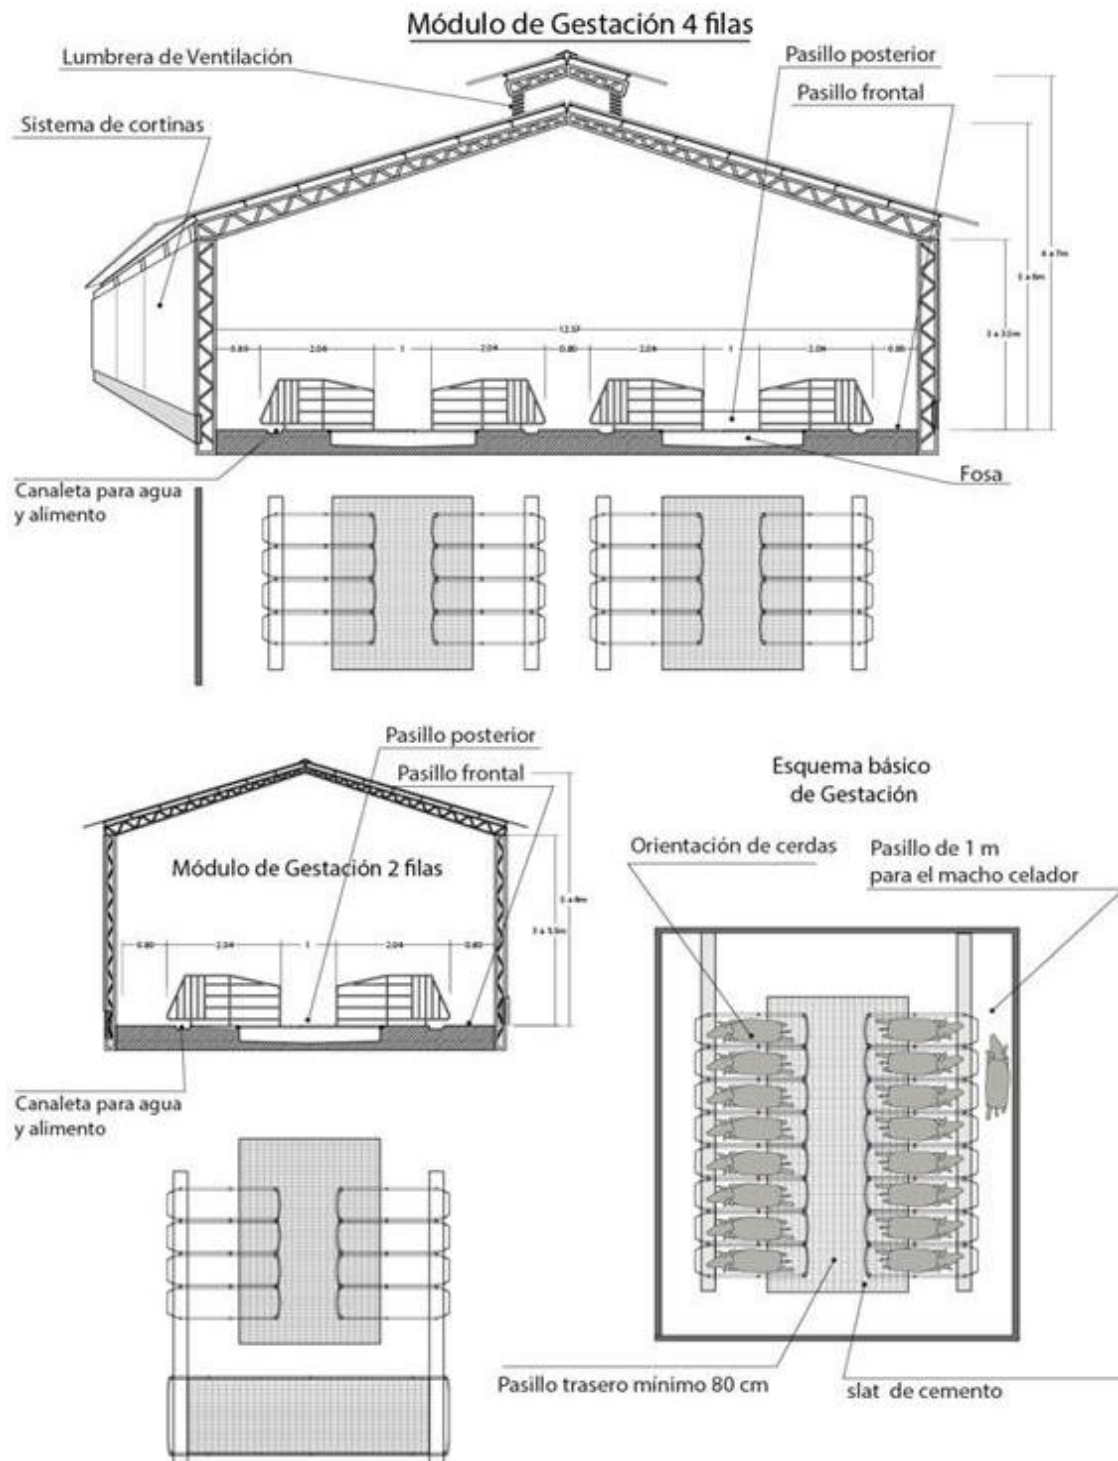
Vistas de corte y planta de galpones de gestación de 2 y 4 hileras de jaulas.
